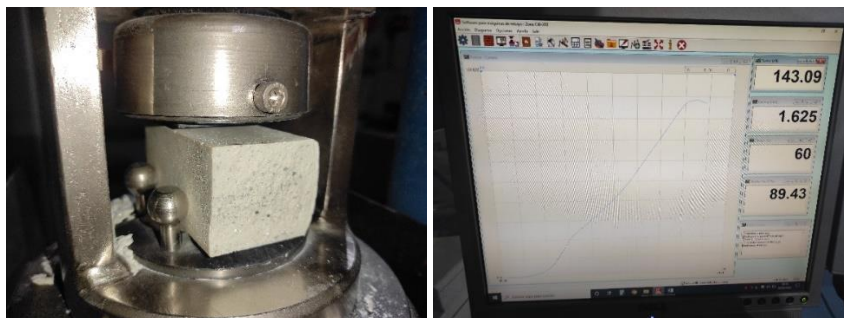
Máquina de ensayo a compresión y sistema de lectura.
